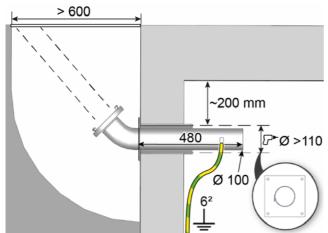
Dimensions pour tubes de remplissage coudés
